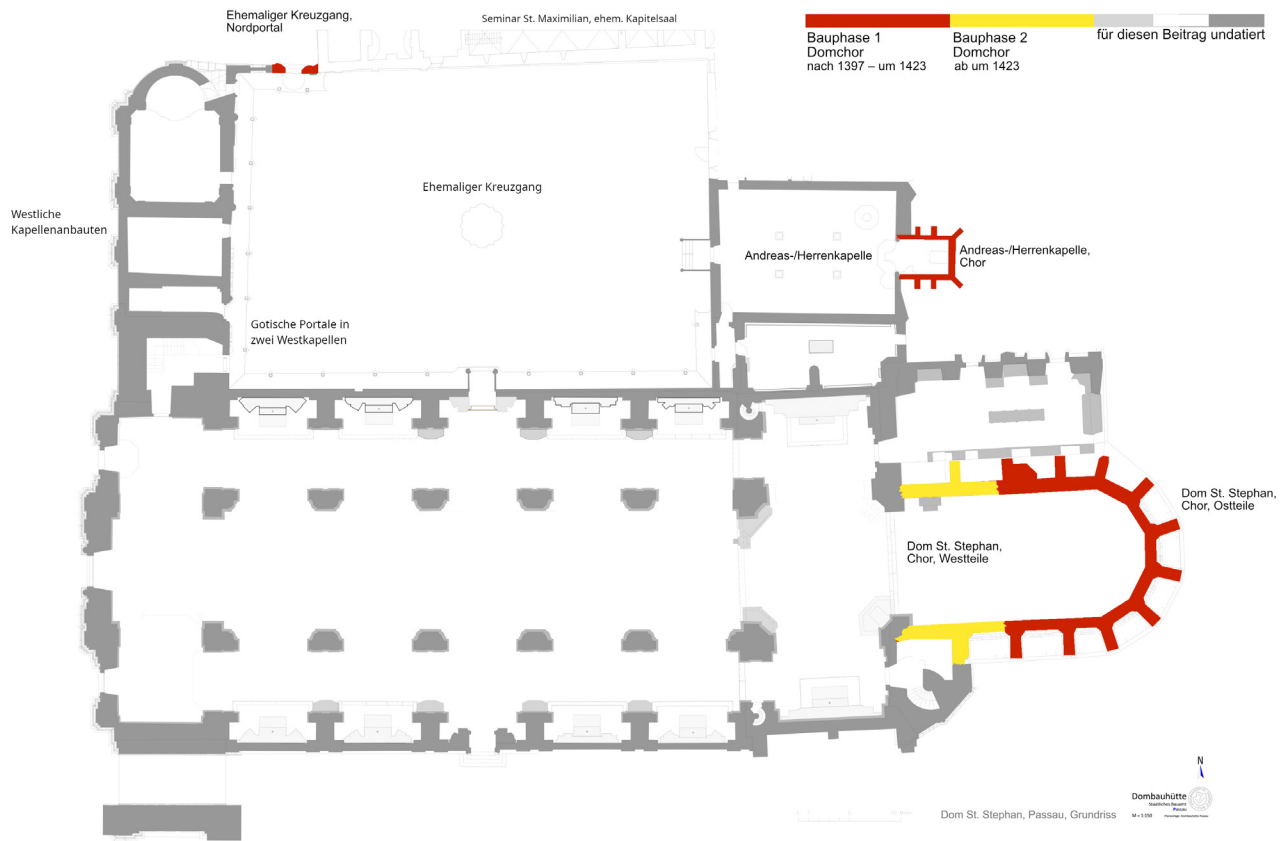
Passau, St. Stephan, Grundriss des Domkomplexes mit Bauphasenmarkierungen
